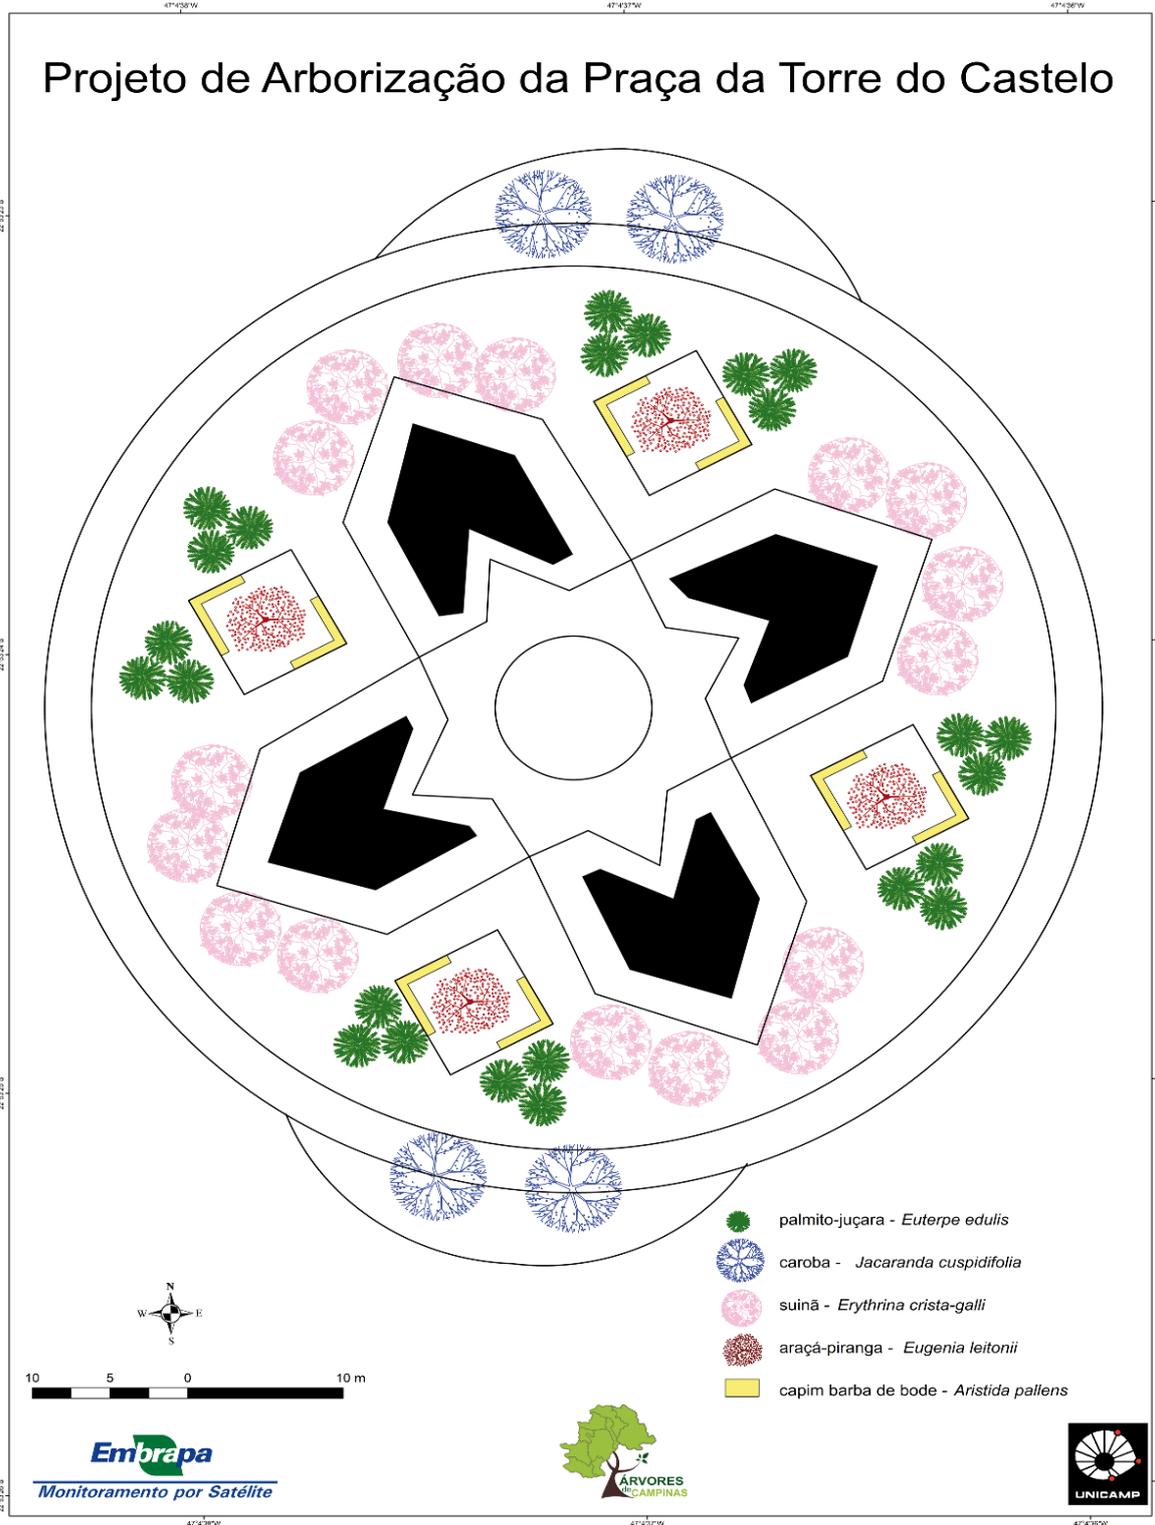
Planta baixa do projeto para rearborização do Balão do Castelo.
